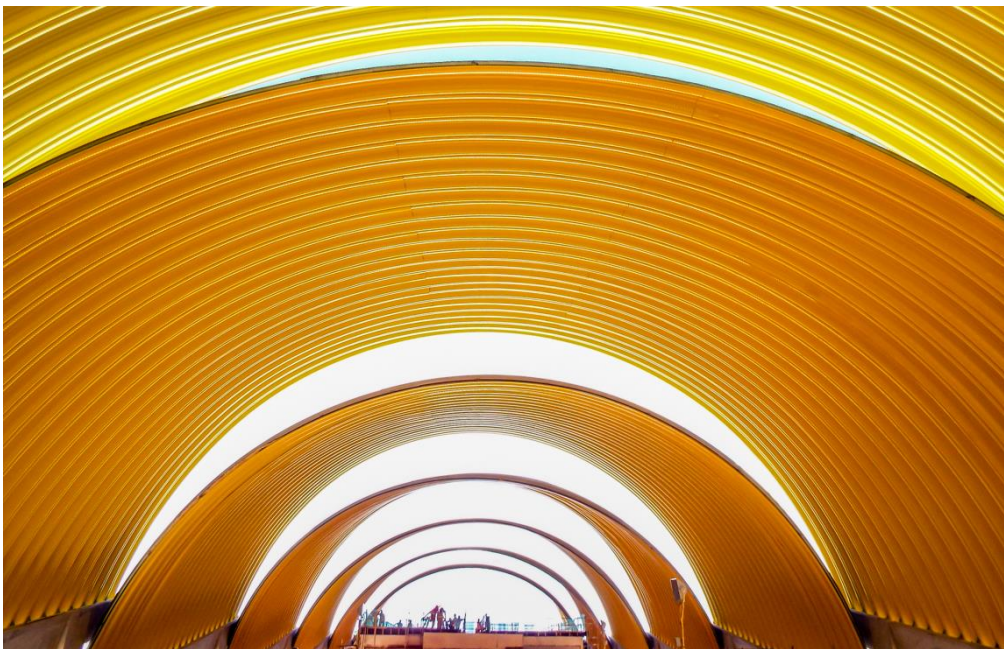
Foto da Estação típica em construção, vista do mezanino (Fonte: Skyscrapercity)
